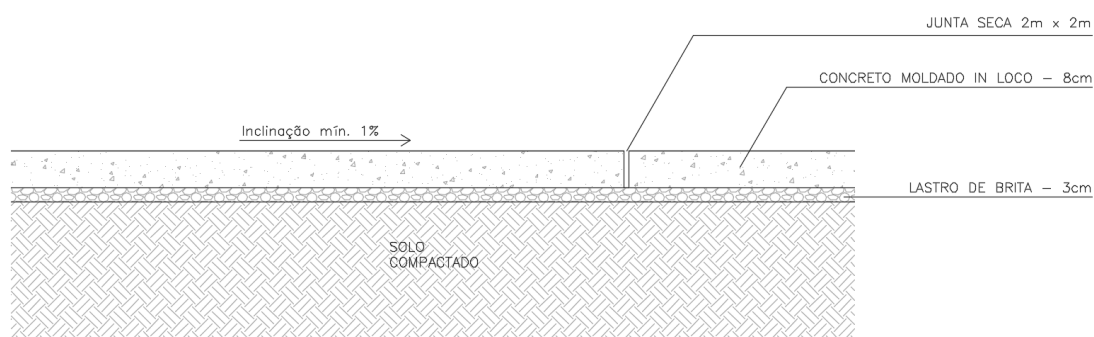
Detalhe de Piso de Concreto Semi polido Moldado in loco
